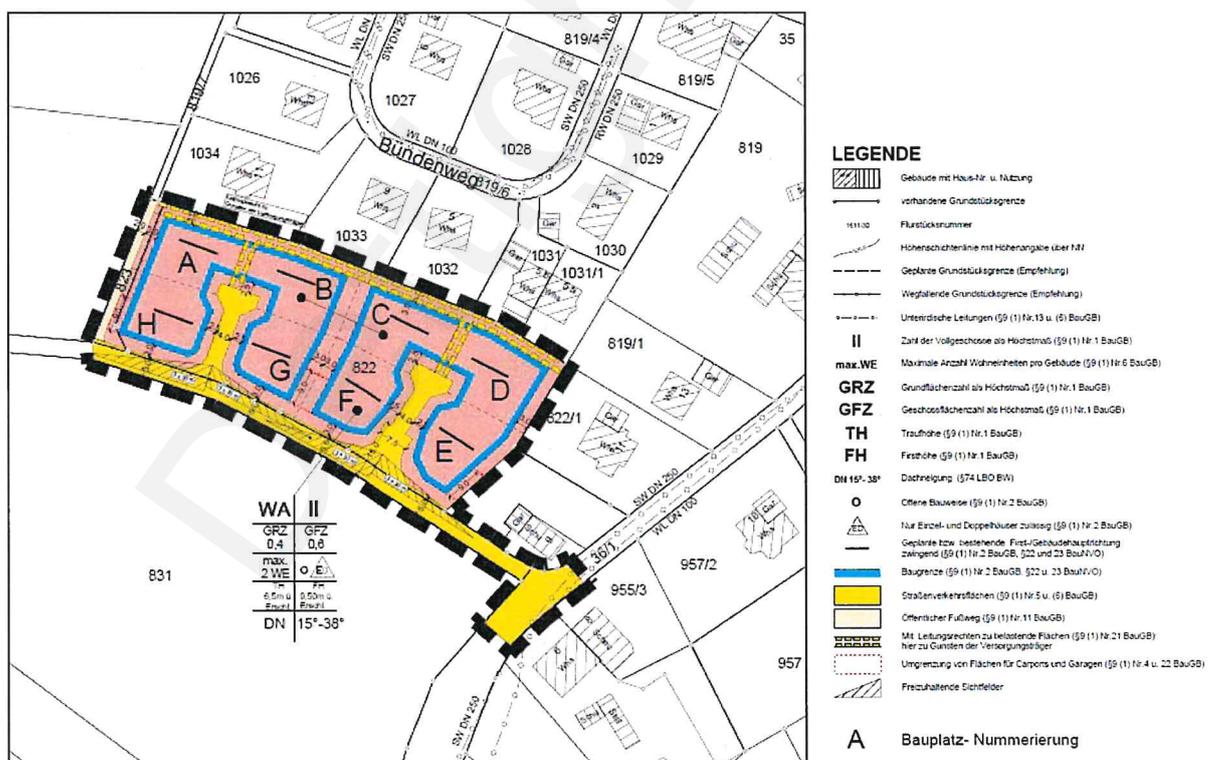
Zuordnung der Vogelnistkästen und Fledermausquartiere entsprechend Bauplatz-Nummerierung. Ausschnitt Rechtsplan zum Bebauungsplan „Bünden III“, geoplan
